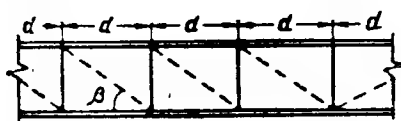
Расчетная схема вертикальной стенки бункера
